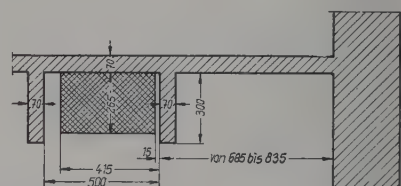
Grundriß und Abmessungen des Installationsschachtes 1:30
